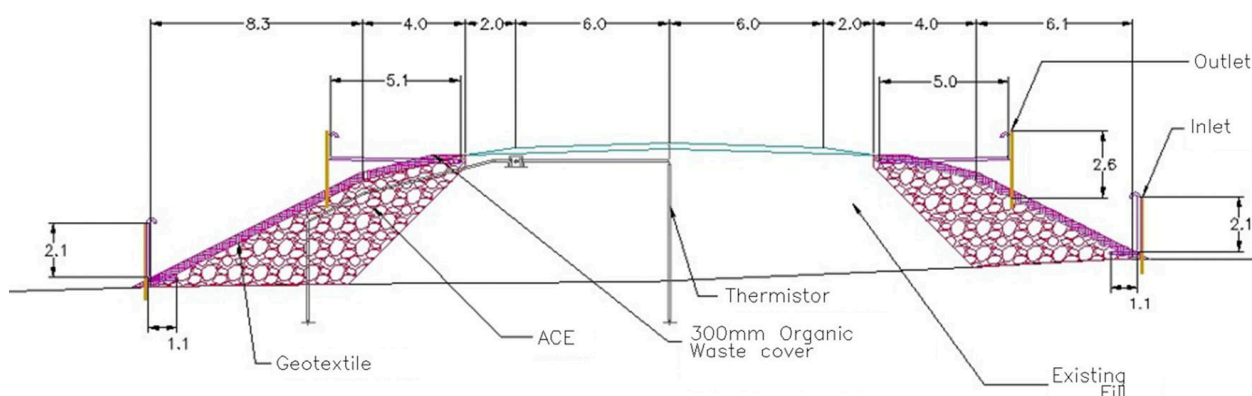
Схема насыпи неполной воздушной конвекции с материалом ACE и вентиляционными трубами: Geotextile – геотекстиль; ACE – воздушно-конвективная насыпь; 300 mm organic waste cover – 300 мм органического отхода; Thermistor – термистор; Existing fill – существующее заполнение (насыпь); Inlet – входное отверстие; Outlet – выходное отверстие вентиляционной трубы
